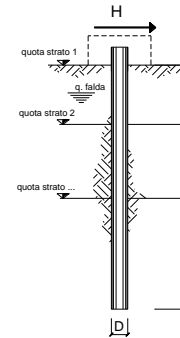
Output di calcolo palo di fondazione spalla SP1, VI01 - Viadotto S. Antonio
